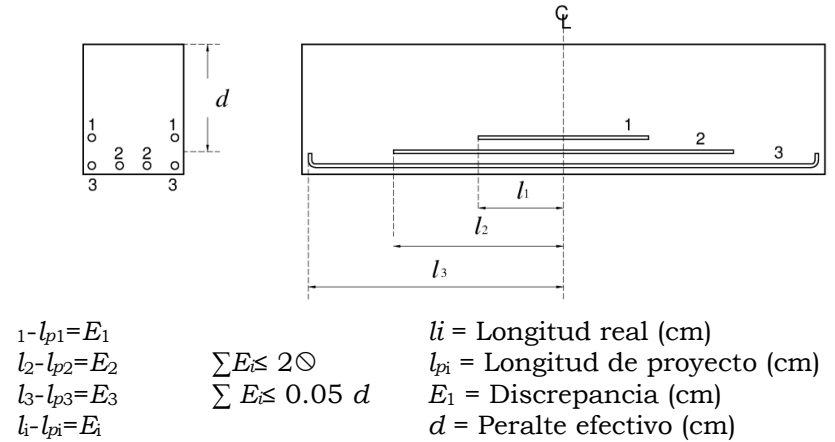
Tolerancias para losas, zapatas, muros, cascarones, trabes o vigas en la dirección del refuerzo principal.
